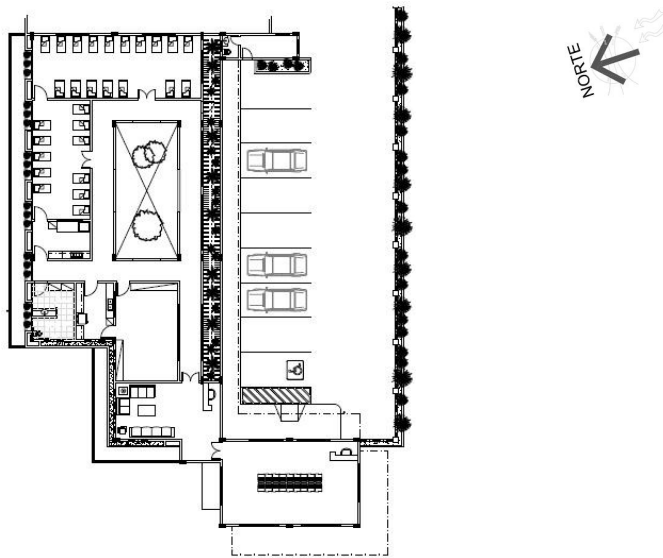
Planta Baixa - Bloco do Berçário, Recepção Principal e Estacionamento interno.
